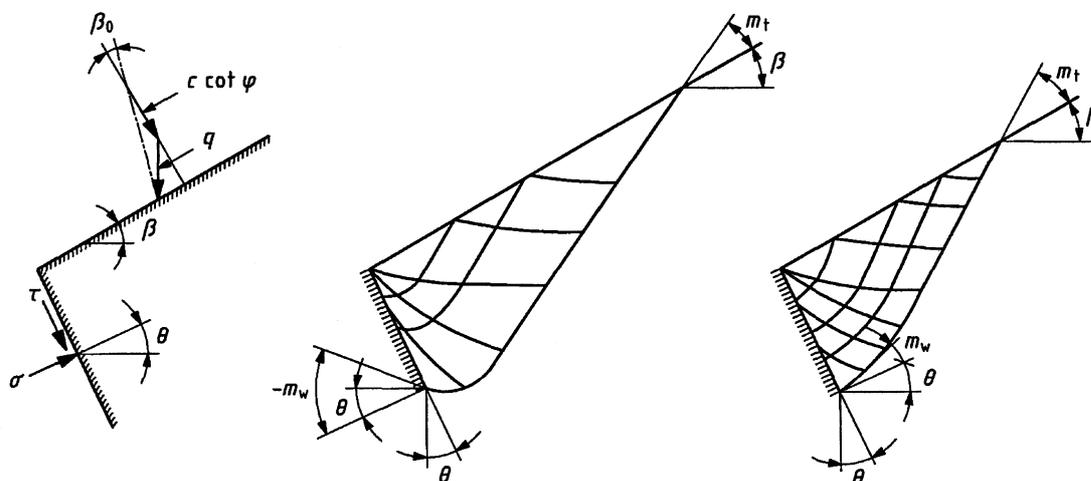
Définitions concernant l'inclinaison d'un ouvrage de soutènement et du remblai, les surcharges et le géométrie de la surface de glissement
